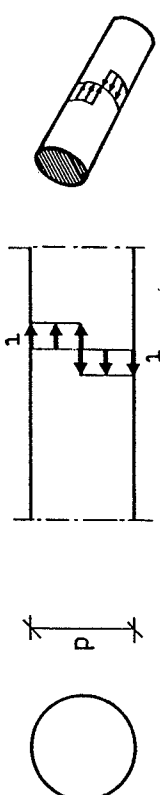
Lokalt brud på grund af stabilitetssvigt i armeringen.
